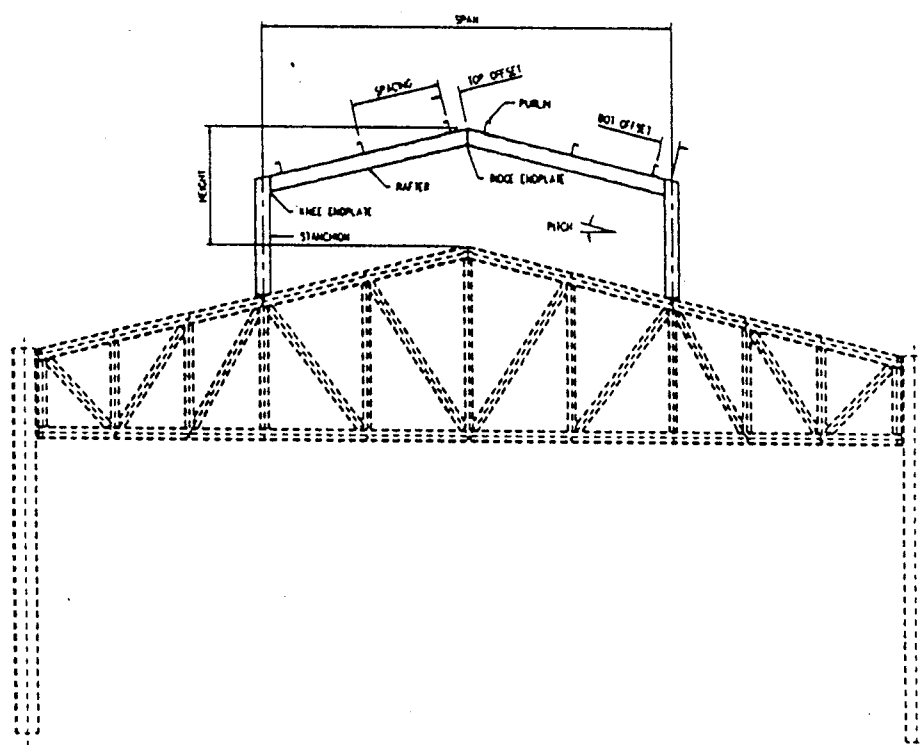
แบบแสดงส่วนประกอบโครงไม้ (1) กรณี FLAT ROOF TRUSS
